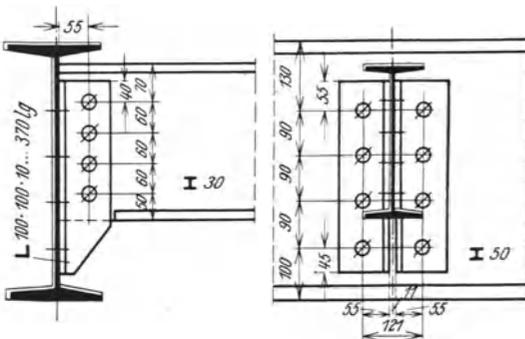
Trägeranschluß mit durchgehenden Anschlußwinkeln.
